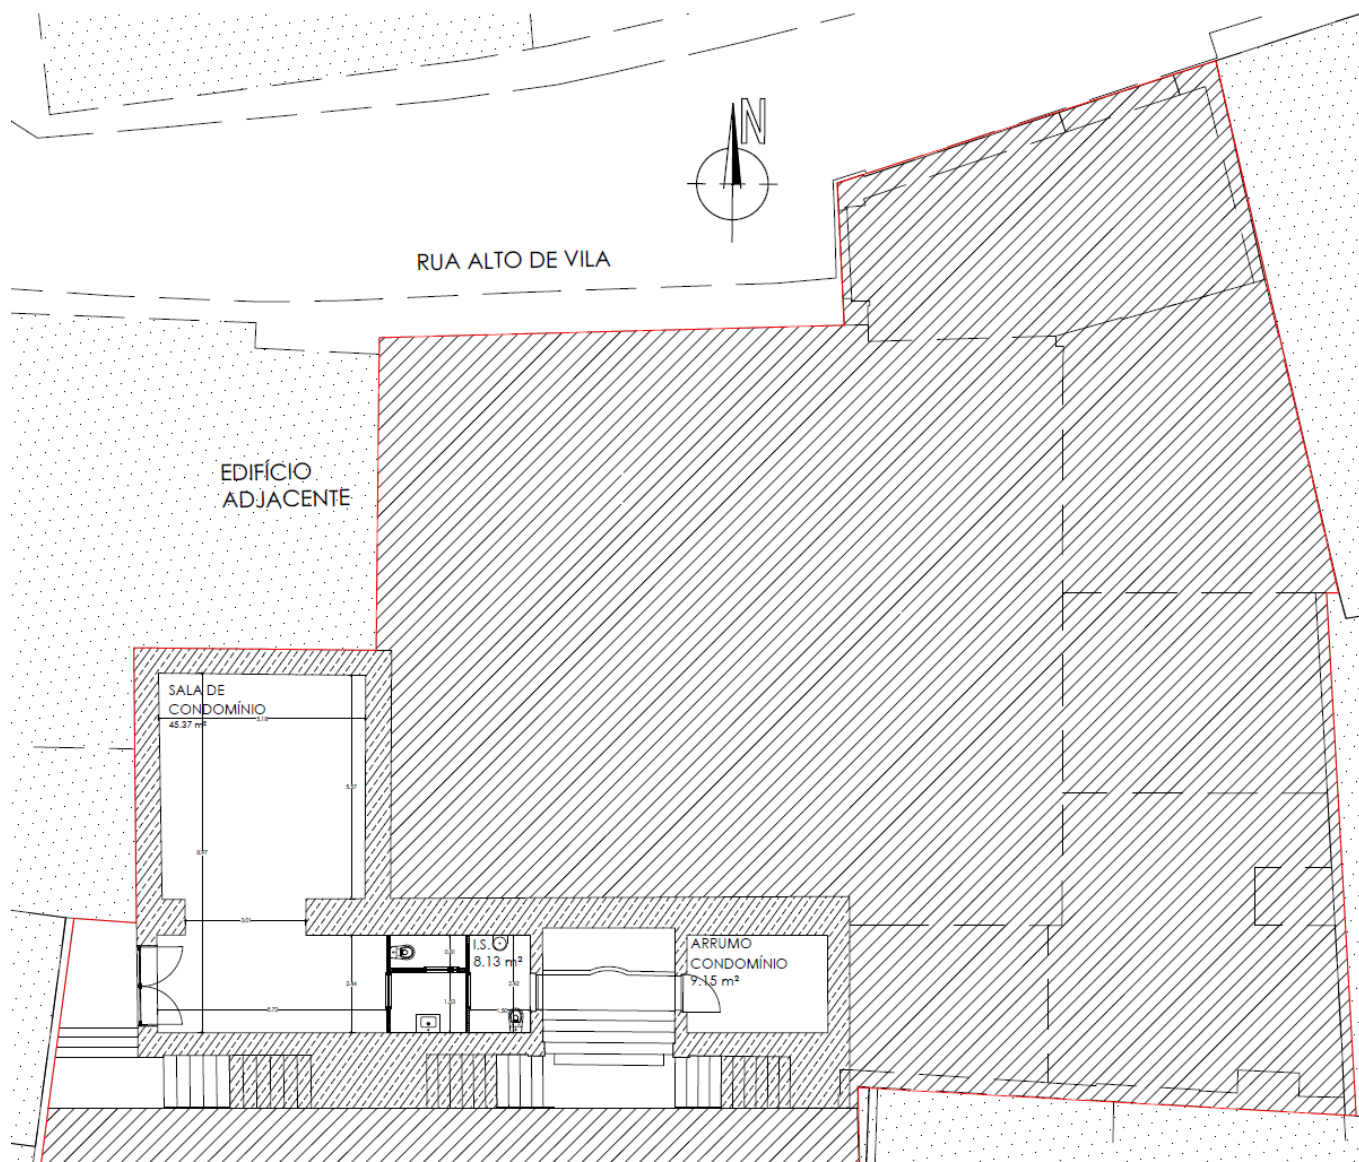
Planta da cave, piso -1, delimitação do terreno.
